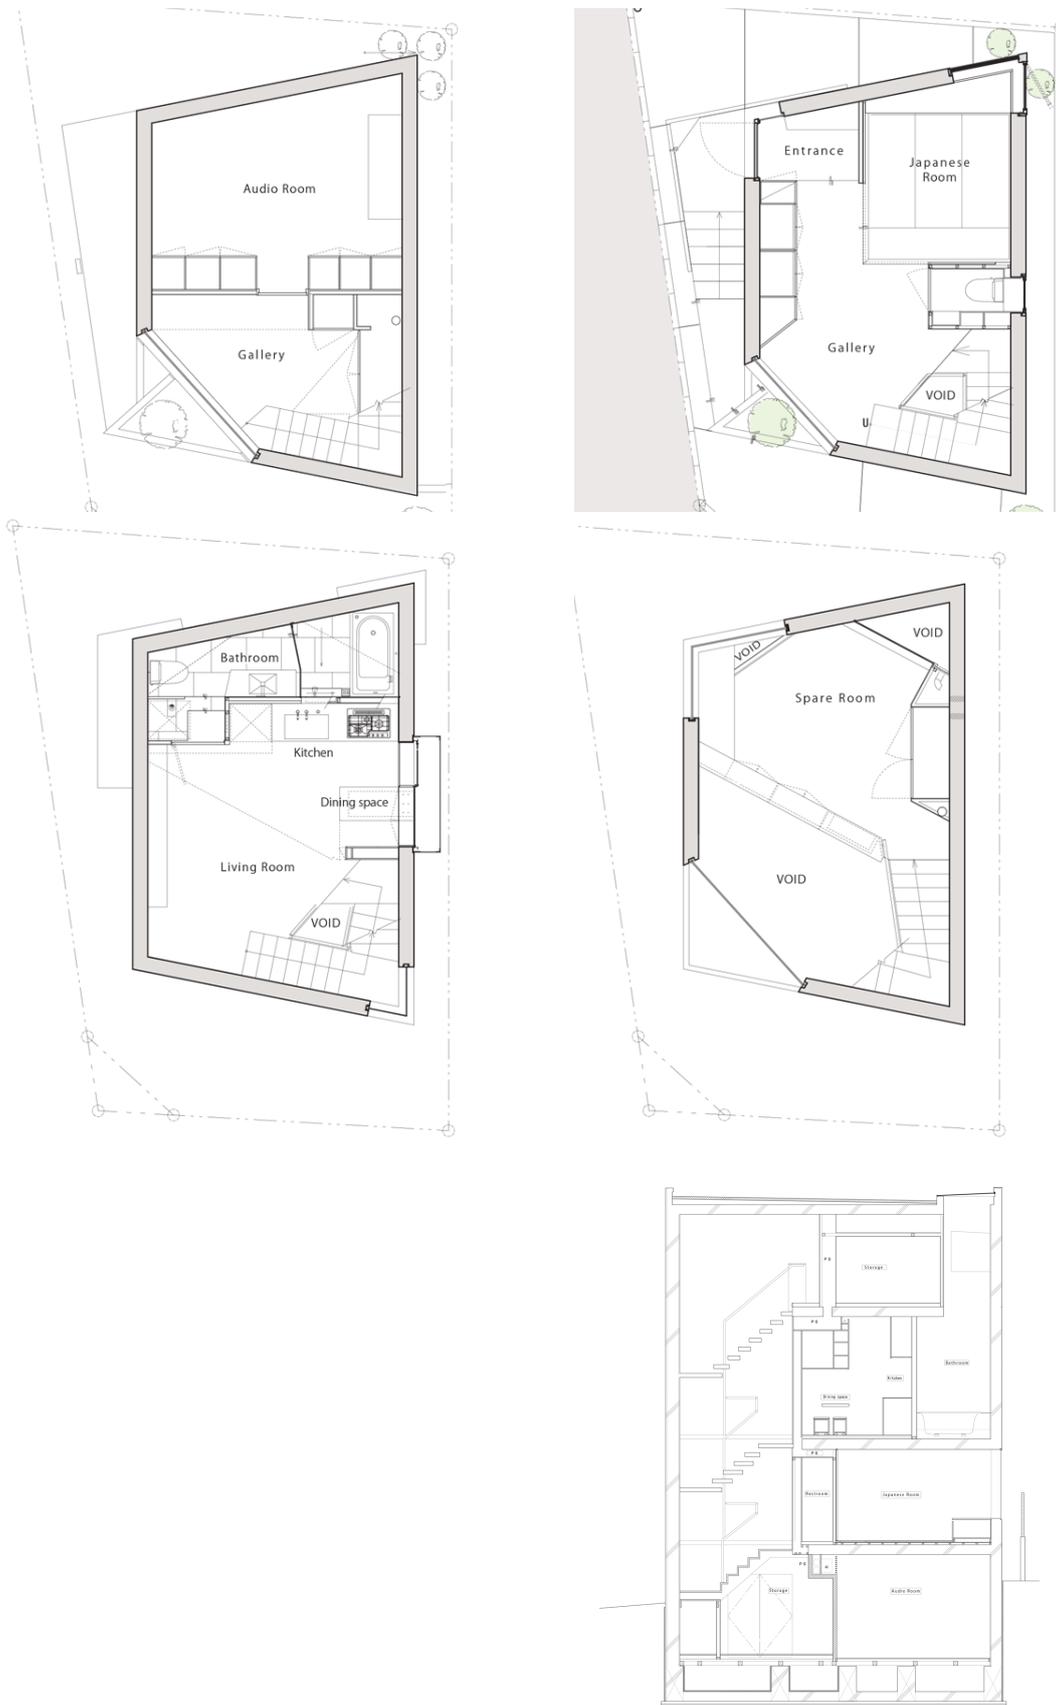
Grundrisse und Schnitt, R torso C
